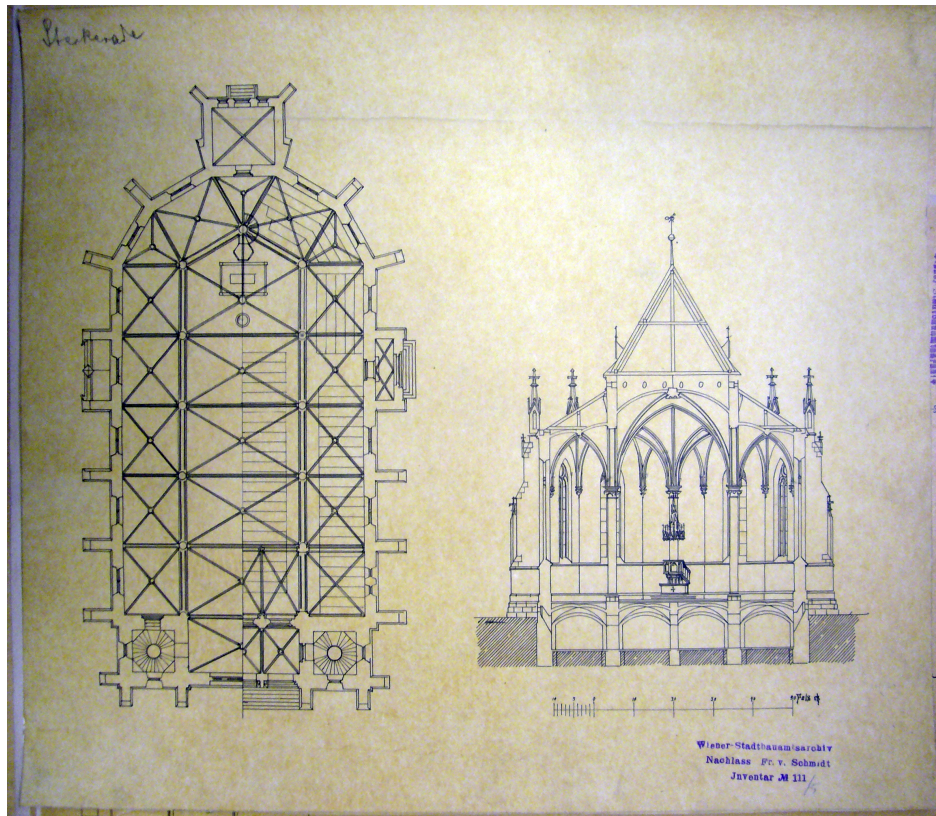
WM, Inv.-Nr. 157.111/5 Grundriss und Querschnitt, Variante
